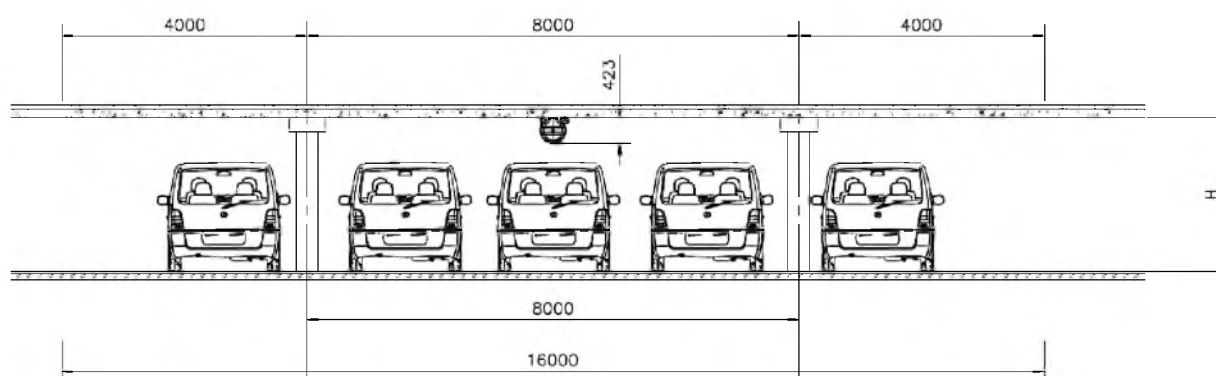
Монтаж струйных вентиляторов над парковочными местами
